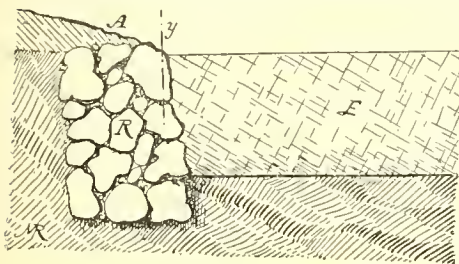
Coupe verticale de la rive d'un empierrement.
